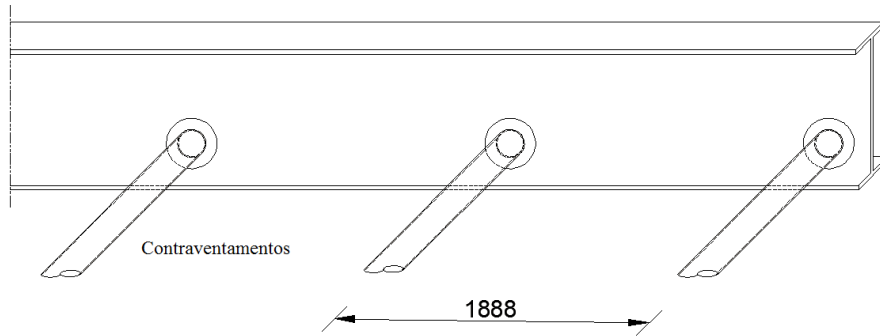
Troço da viga (de bordadura) contraventada lateralmente
